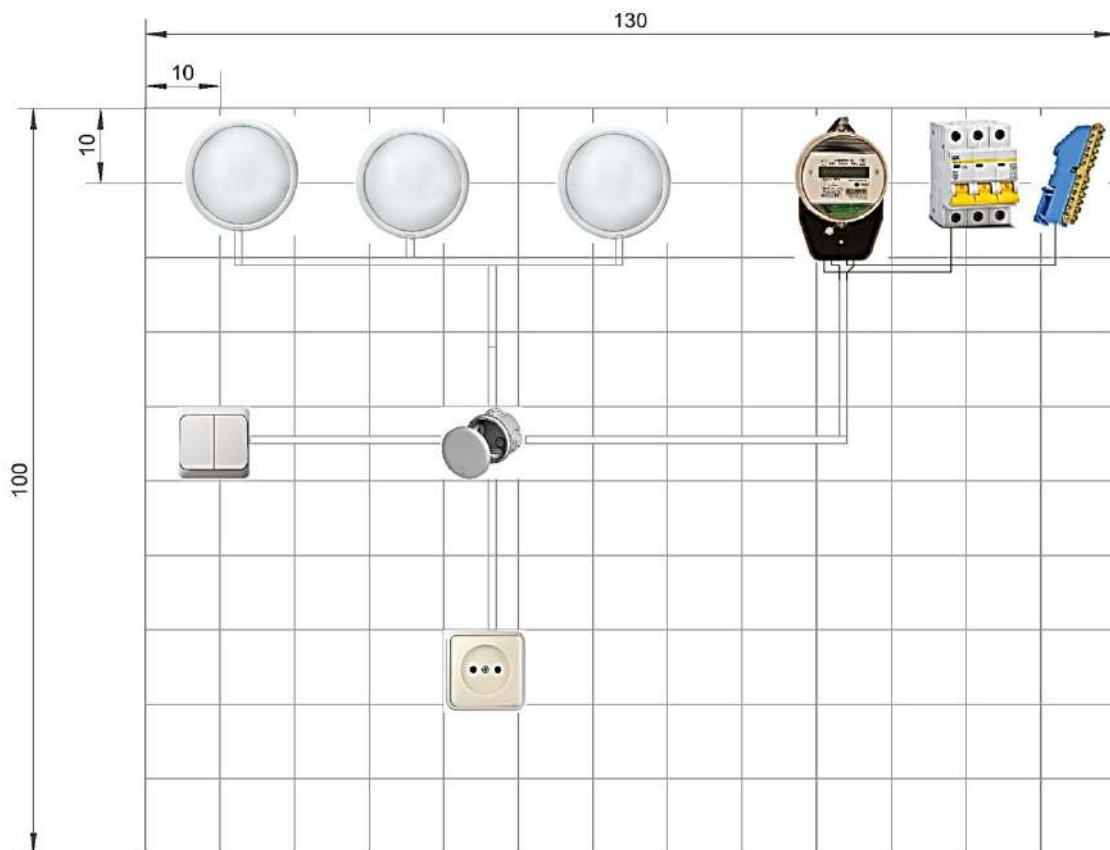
Эталон выполнения осветительной сети, 2 вариант
